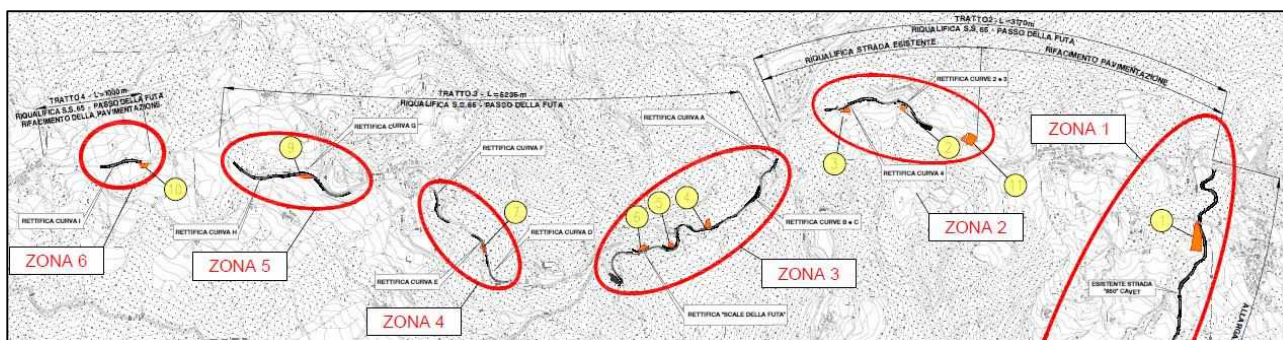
Quadro di insieme della cantierizzazione (stralcio da CAP0200)
